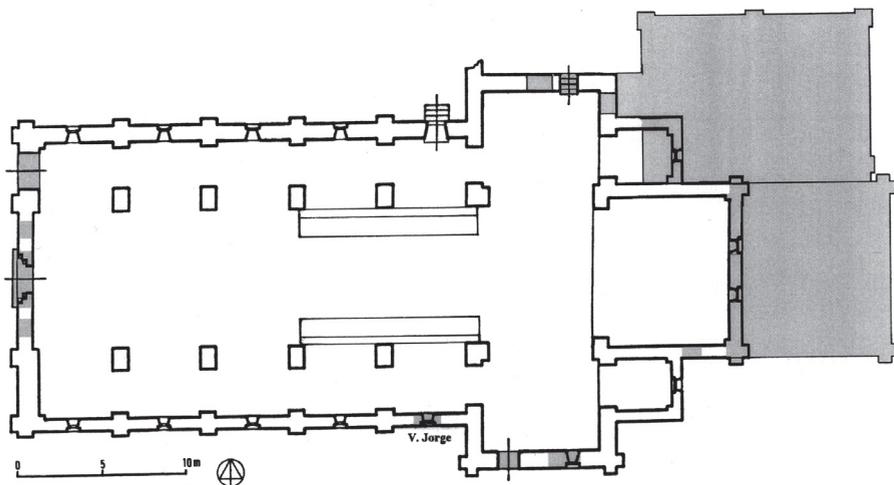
Mosteiro de São João de Tarouca, igreja. Planta actual (a pontilhado indicam-se as obras pós-medievais).
